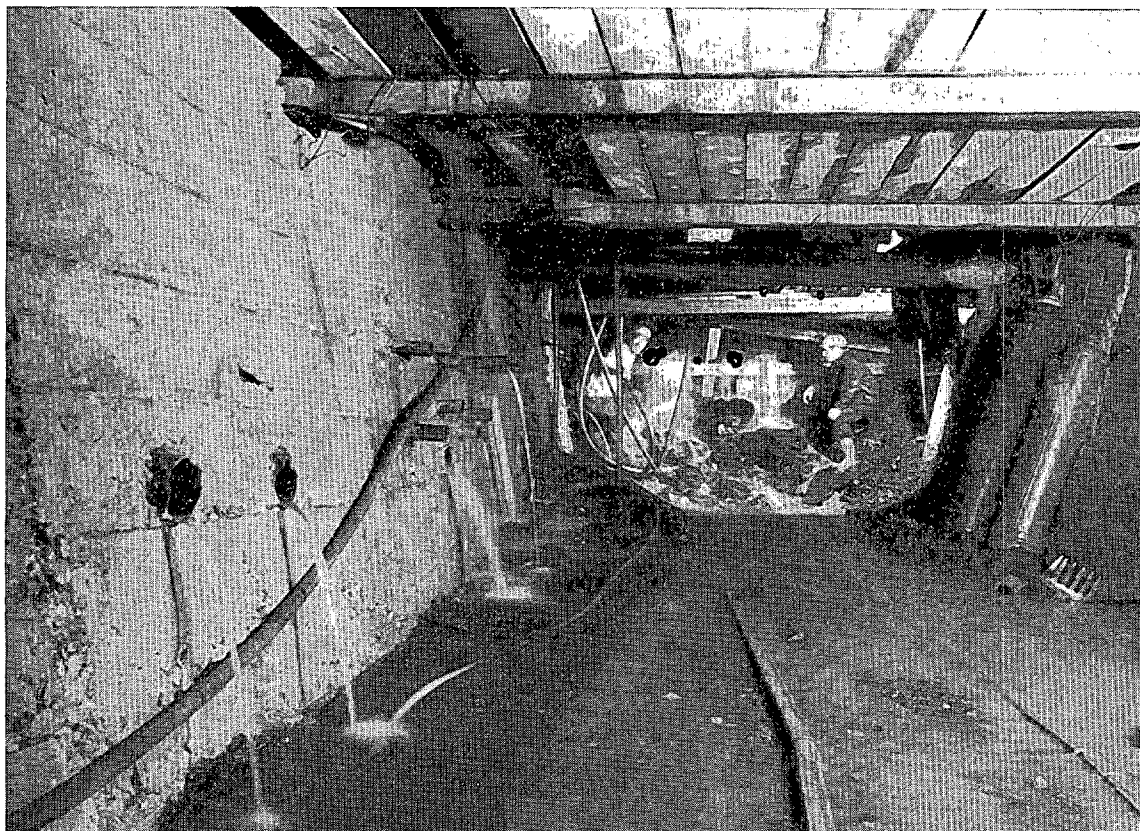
Falla de los Poyales. Drenajes embebidos en el preanillo de hormigón.
